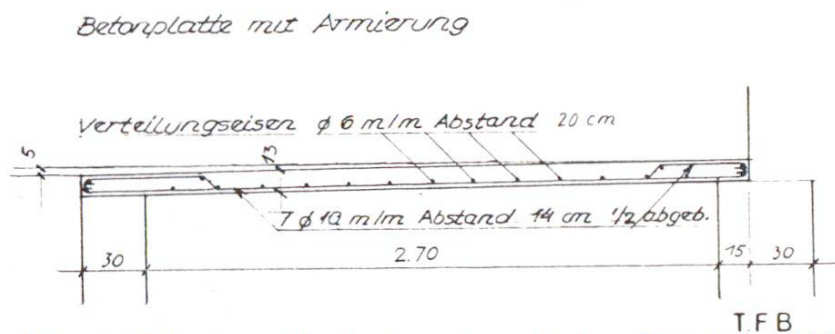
Abdeckung der Jauchegrube mit einer Eisenbetonplatte
